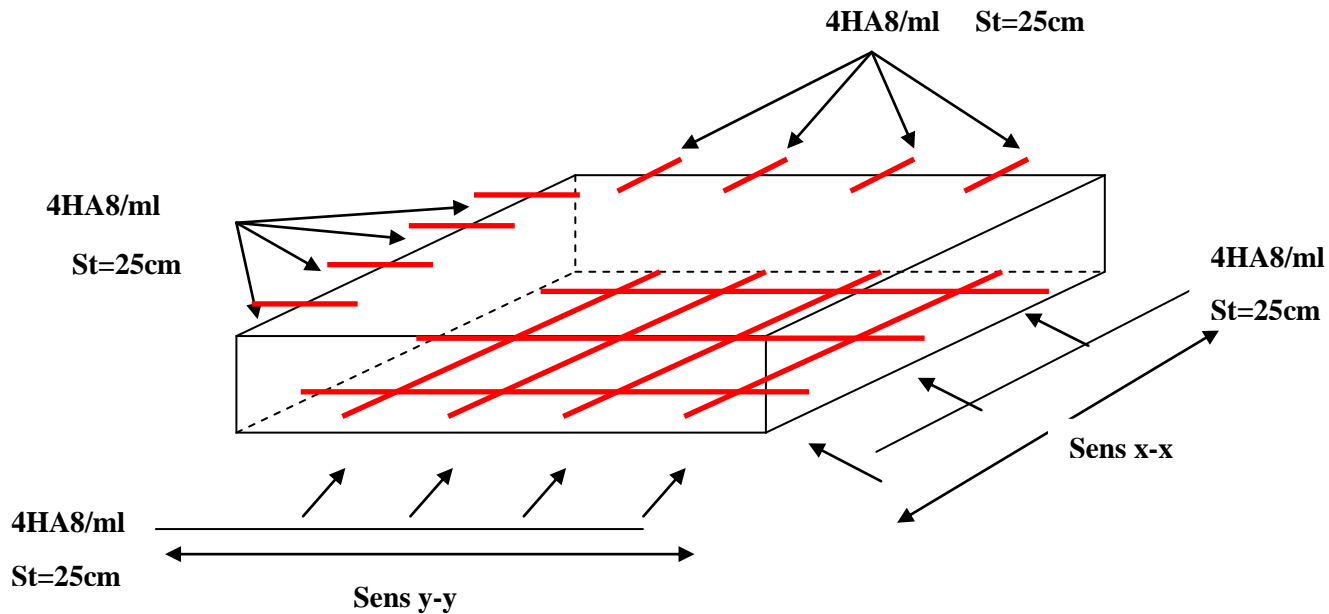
Schéma de ferrailage de la dalle pleine du local machinerie.
